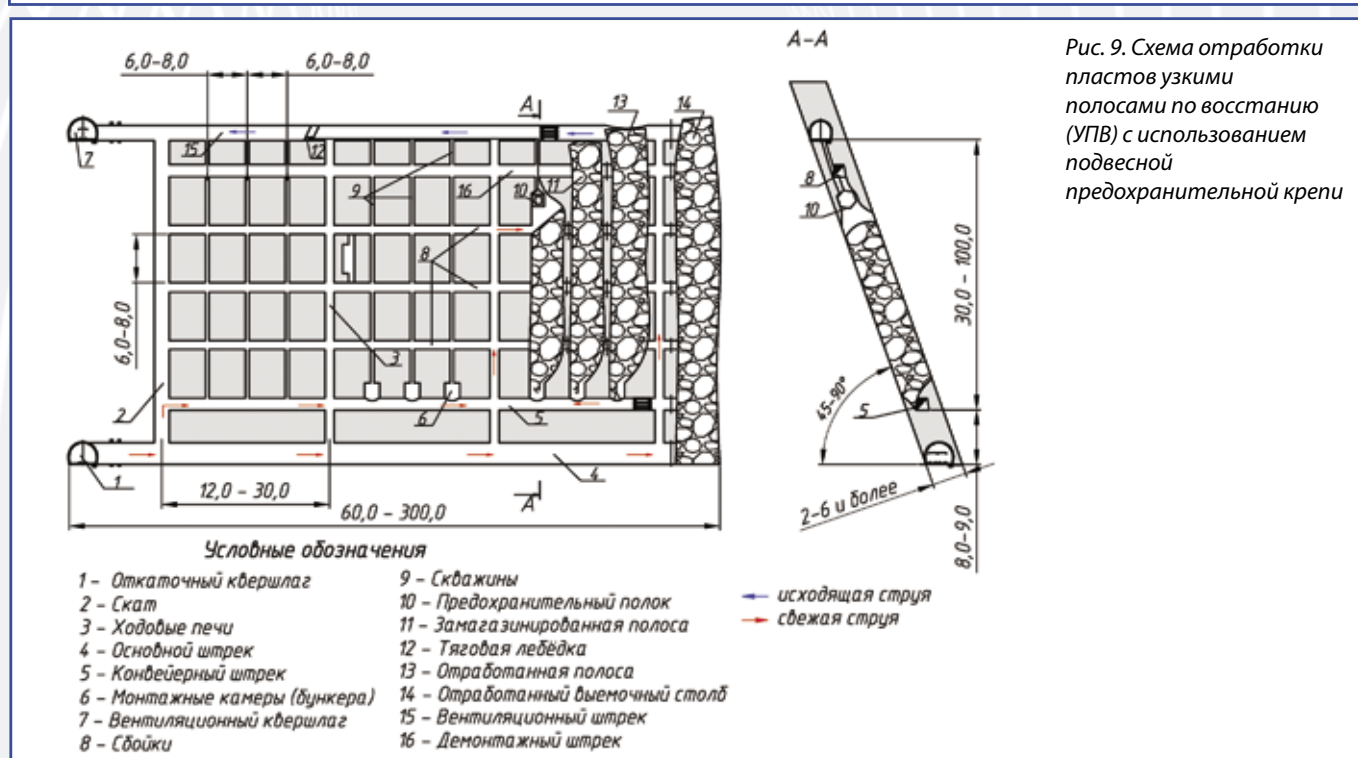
Схема отработки пластов узкими полосами по восстанию (УПВ) с использованием подвесной предохранительной крепи
